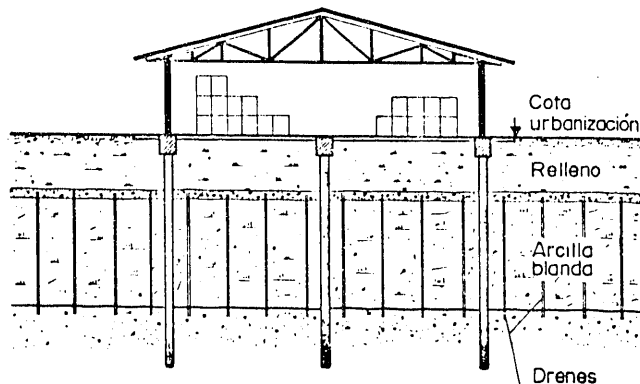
Consolidación del terreno con precarga y drenes antes de acometer la cimentación.
